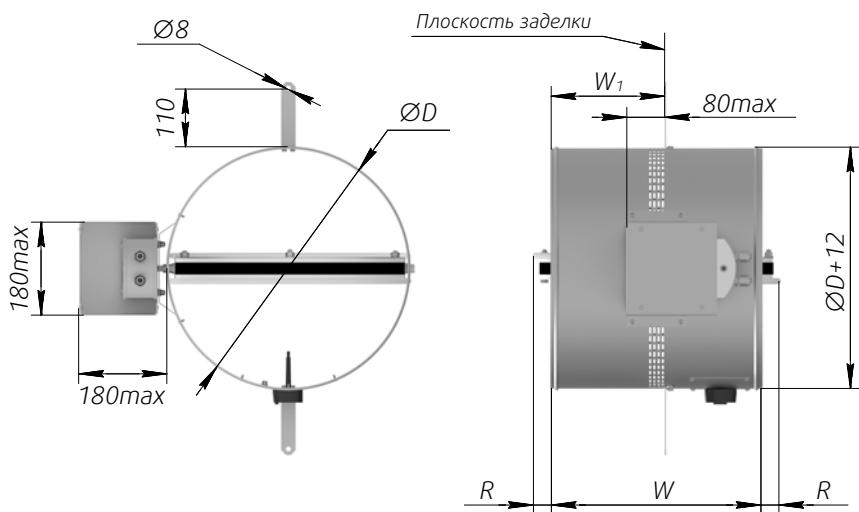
в. Размеры ниппельного клапана HELMER, EI90 (с возможностью стеновой заделки)
